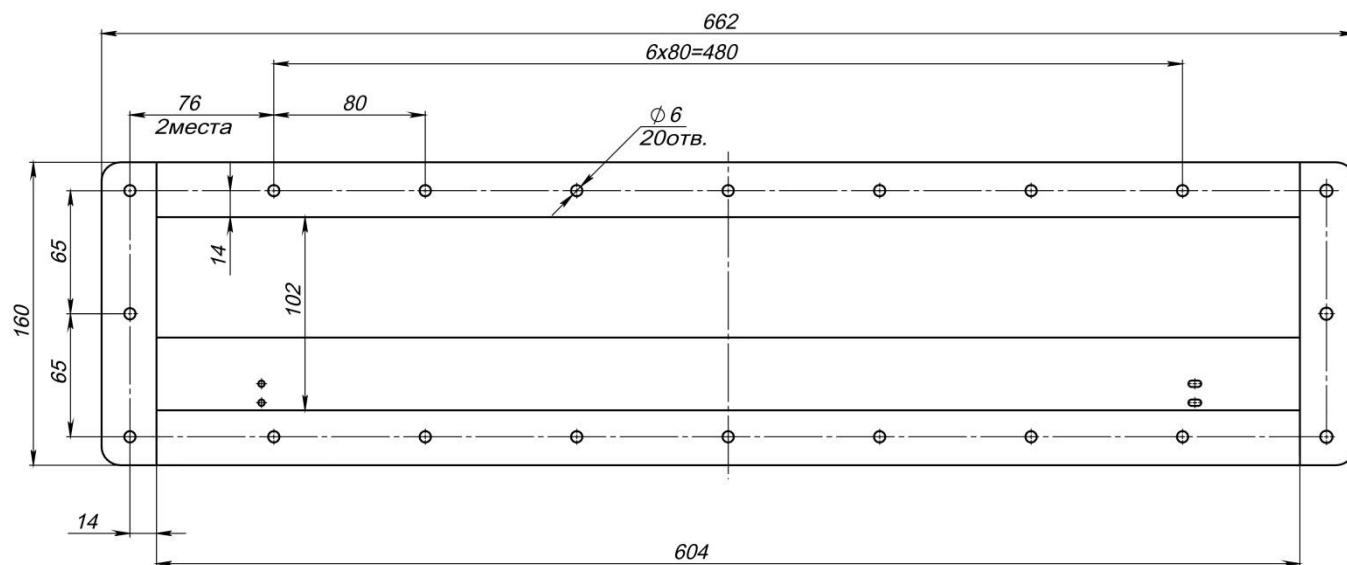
Схема разметки отверстий для крепления КСИД-П площадью проходного сечения 600 см<sup>2</sup>.
